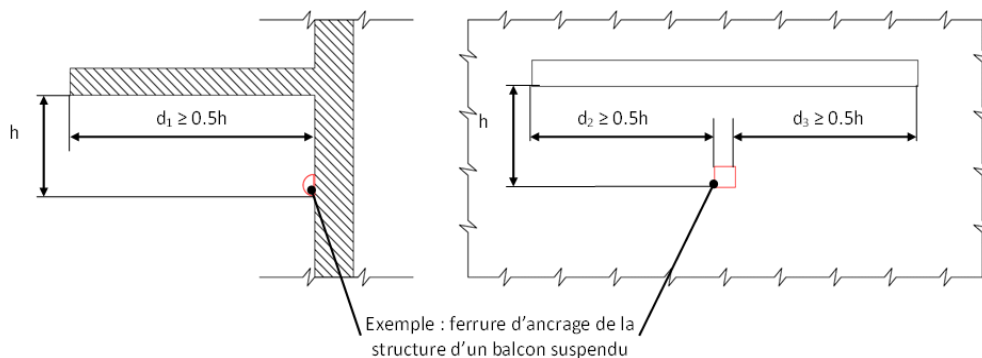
Représentation des critères de protection des traversées ponctuelles de l'ETICS par une ferrure d'assemblage ou poutre
